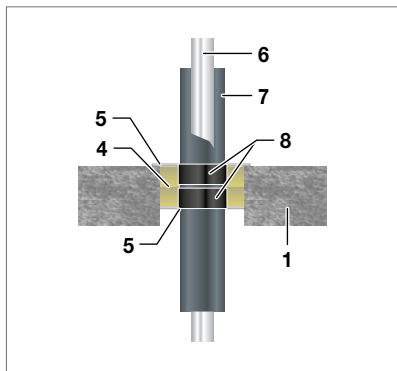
Weichschott in der Massivdecke mit Viega Rohrleitungssystem Metall
